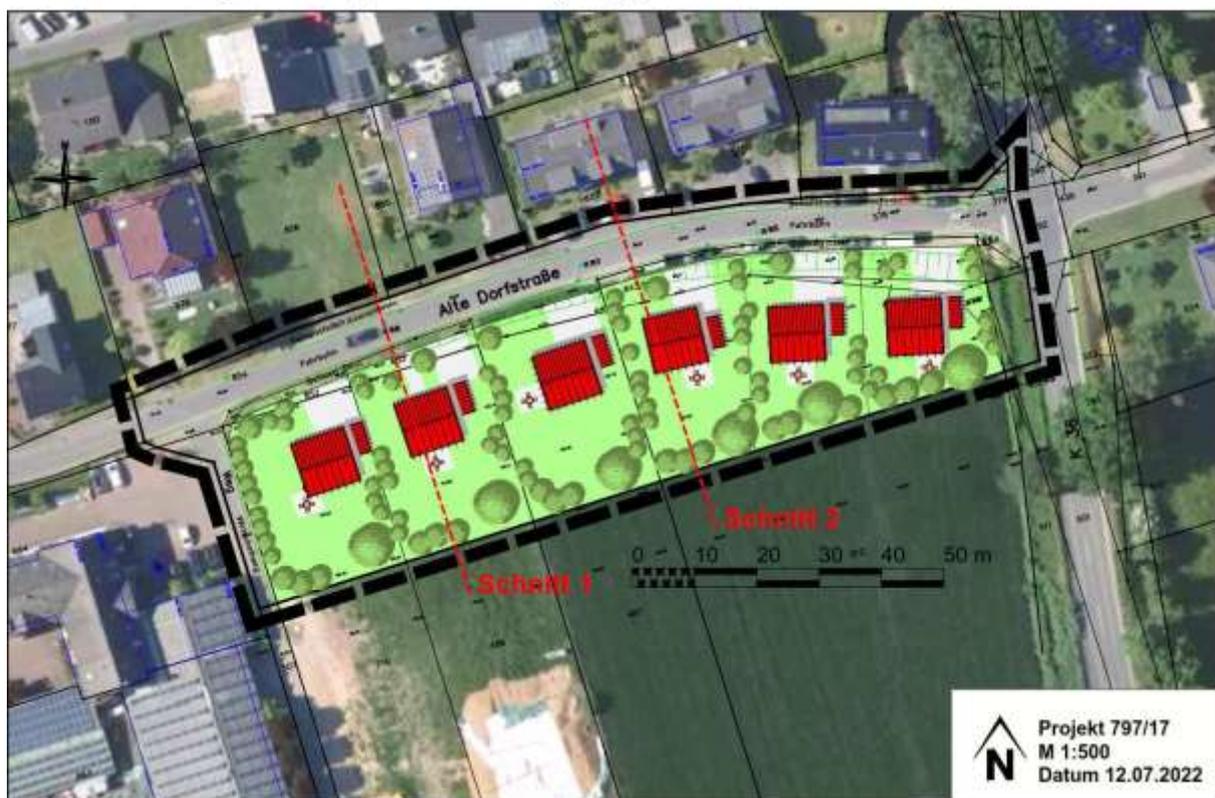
Bebauungskonzept vom 12.07.2022, Planungsbüro Dittrich
